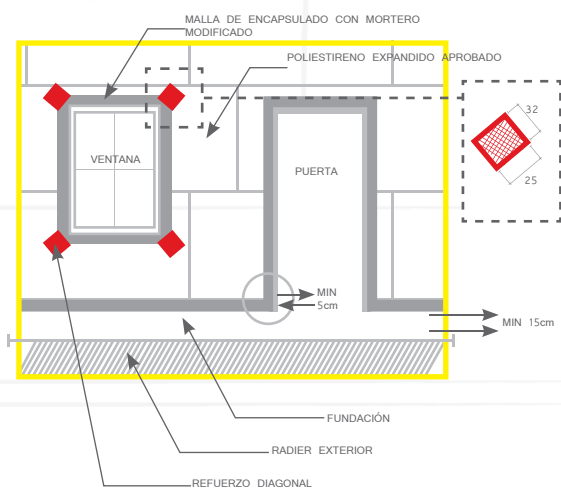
l: Disposición de refuerzos en esquinas en sistema EIFS de barrera, (elevación).
